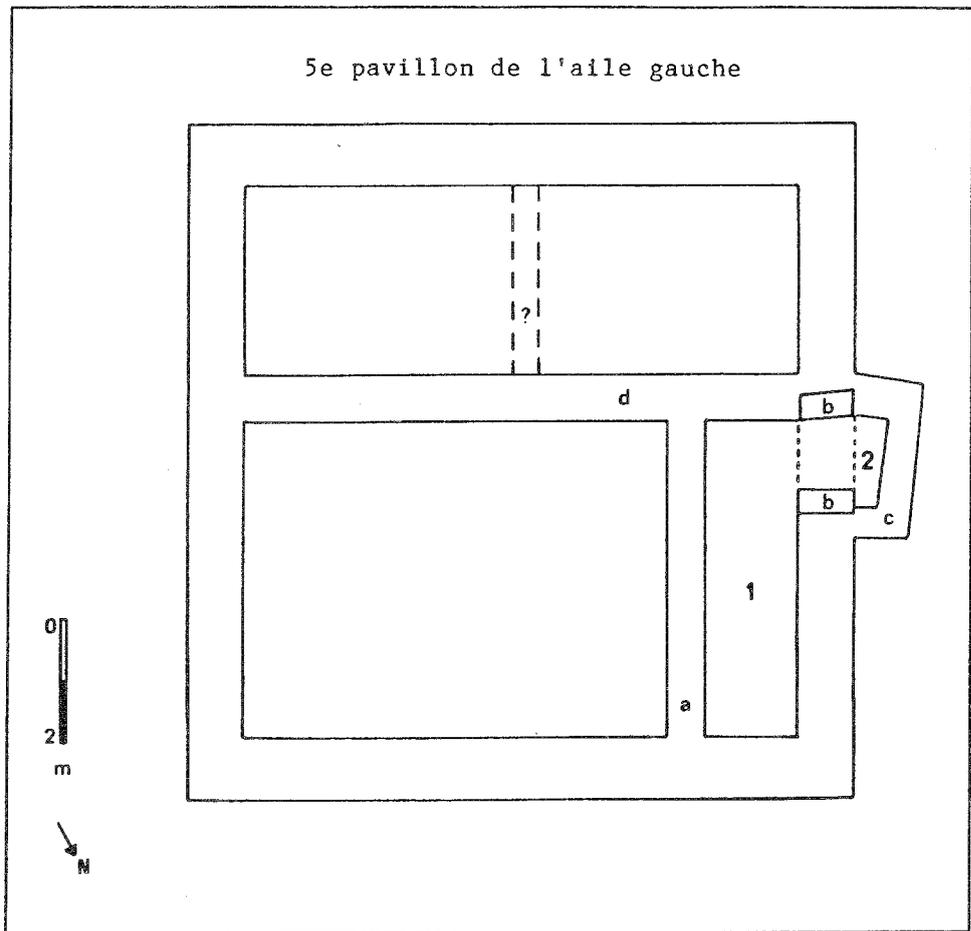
Plan des fondations du Pavillon des bains (fouilles de 1990).
